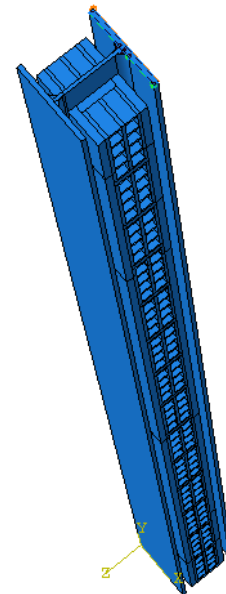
Assembly* HE 160 A com alma perpendicular à parede
